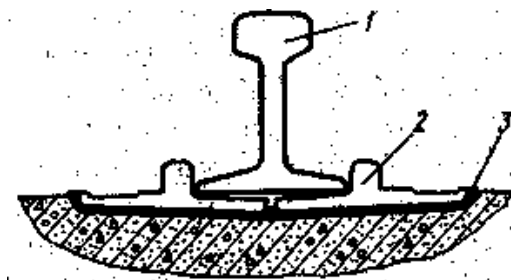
Кромочное опирание подошвы рельса после излома подкладки:
